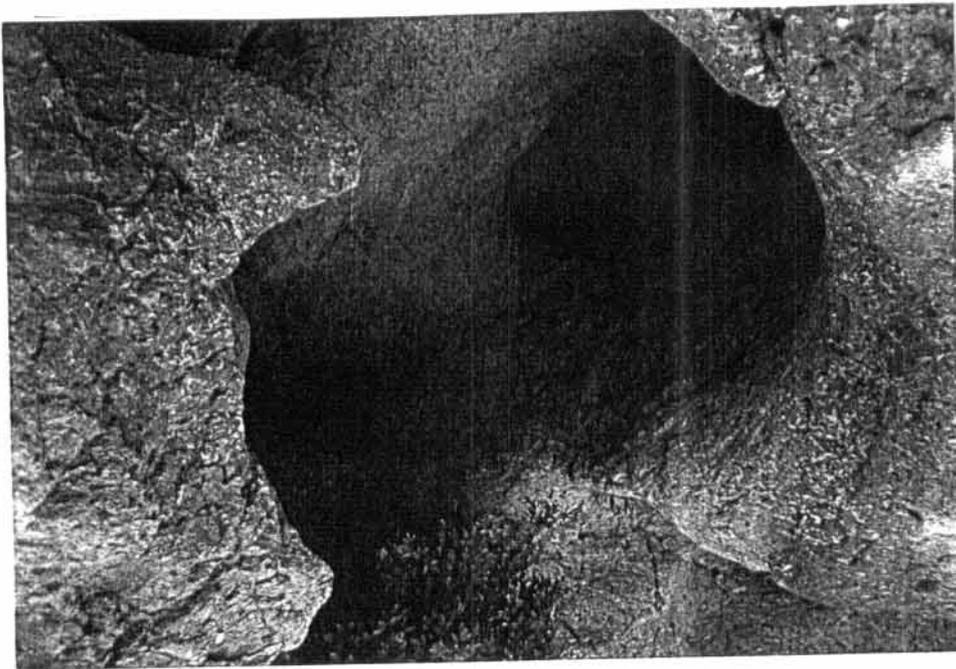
Marmite de géant creusé dans la carapace à l'embouchure du caniveau N°1 (Nienéta sur le Wé)
